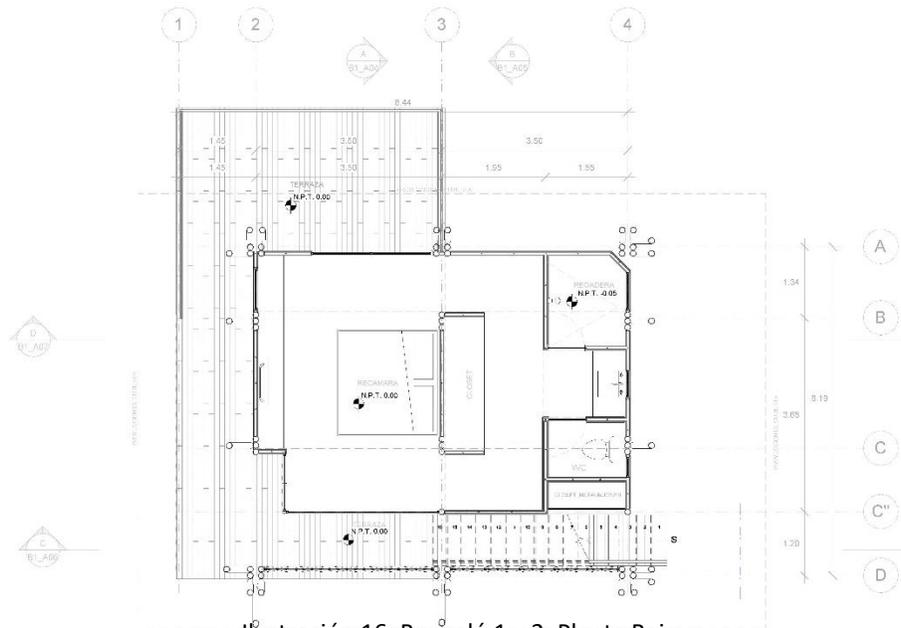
Bungaló 1 y 2, Planta Baja.
